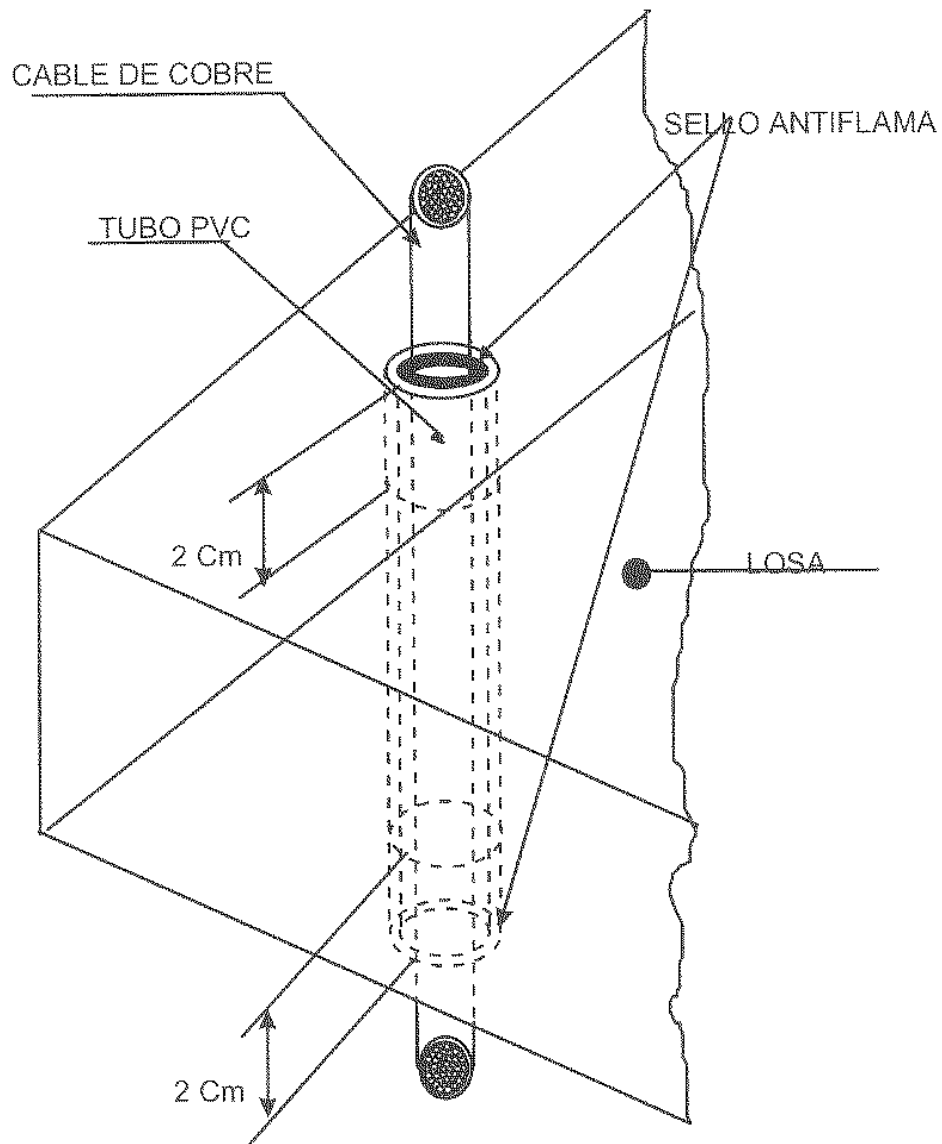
Paso de Cable por Losa Mediante Tubo Conduit de PVC.
